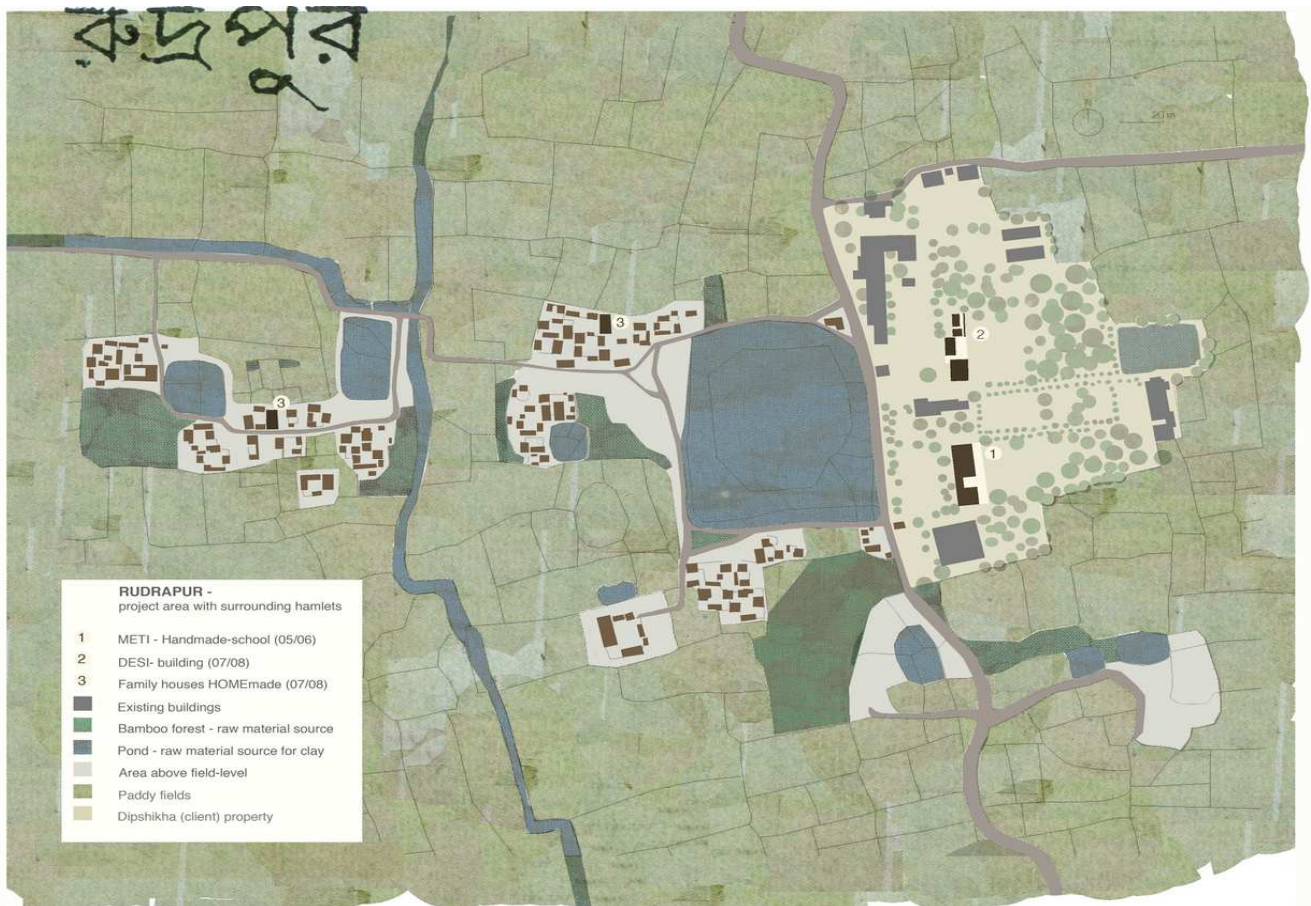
Plan directeur de Rudrapur avec le projet Meti Handmade School.
